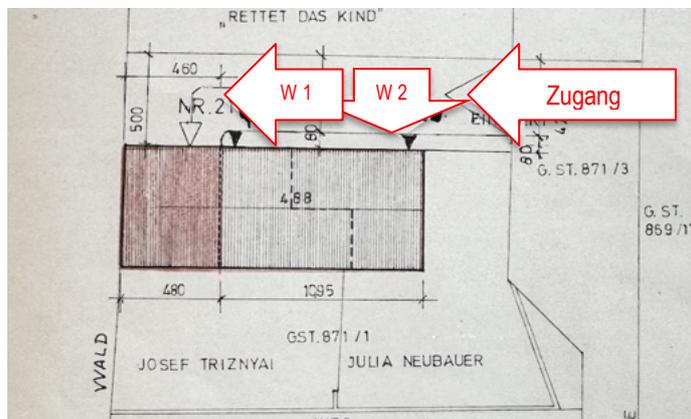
Einreichplan September 1999 Franz Liszt-Straße 21 (nicht bewilligt)
